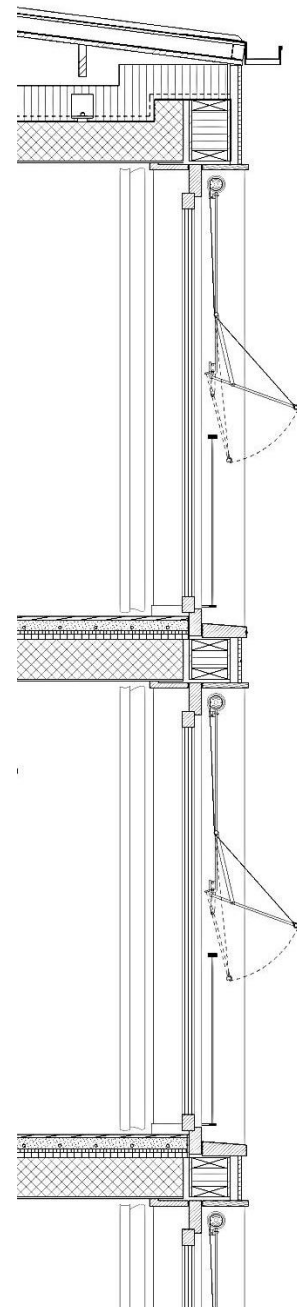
Planausschnitt Bauprojekt des Architekten basierend auf dem Input durch den Holzbauingenieur
